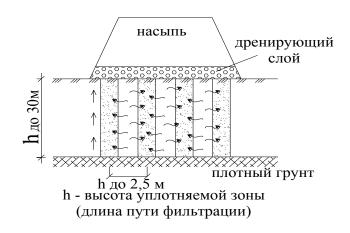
Схема уплотнения грунтов с помощью вертикальных дрен
